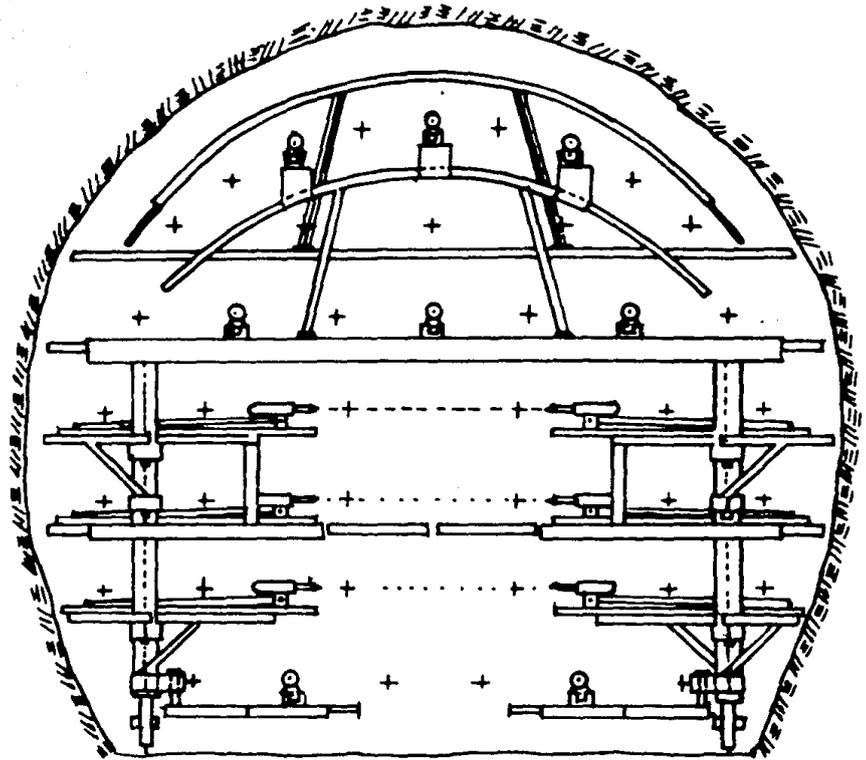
VISTA TRANSVERSAL DE UNA JUNBO DE PORTICO
